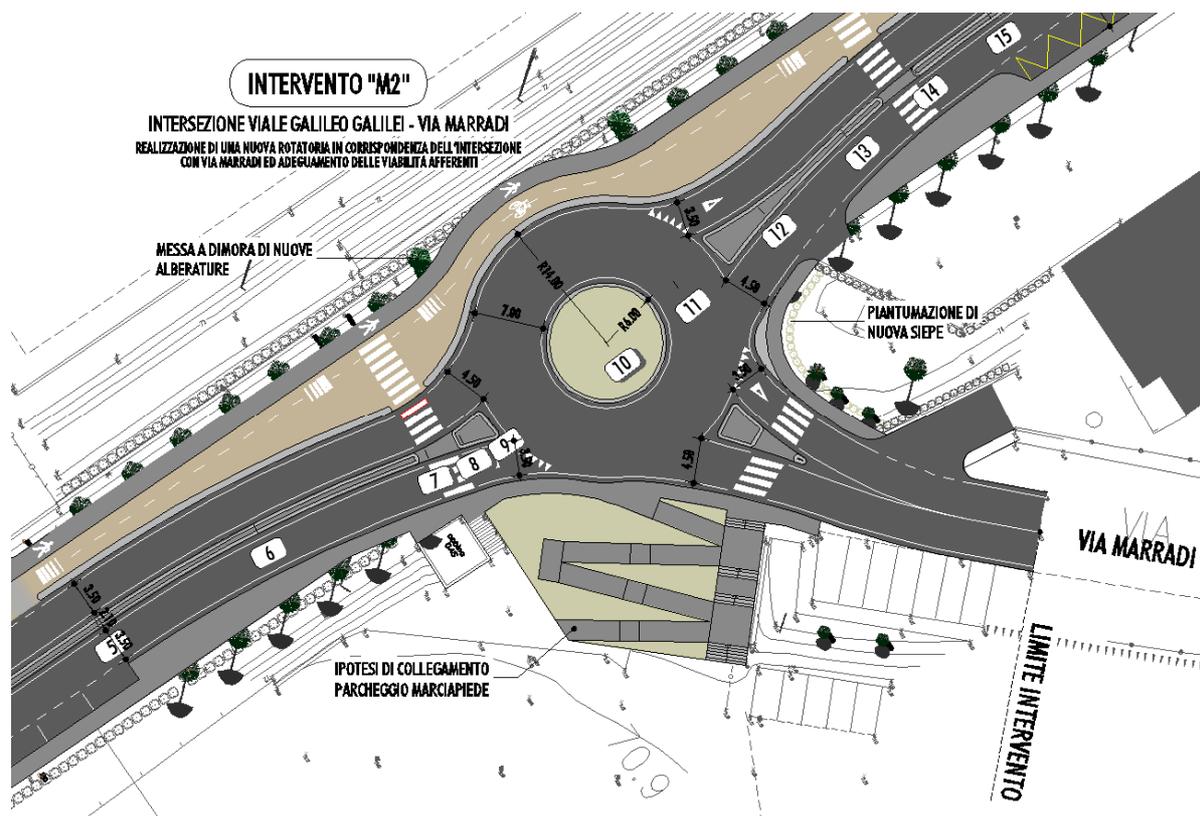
Planimetria di progetto – dettaglio rotatoria
